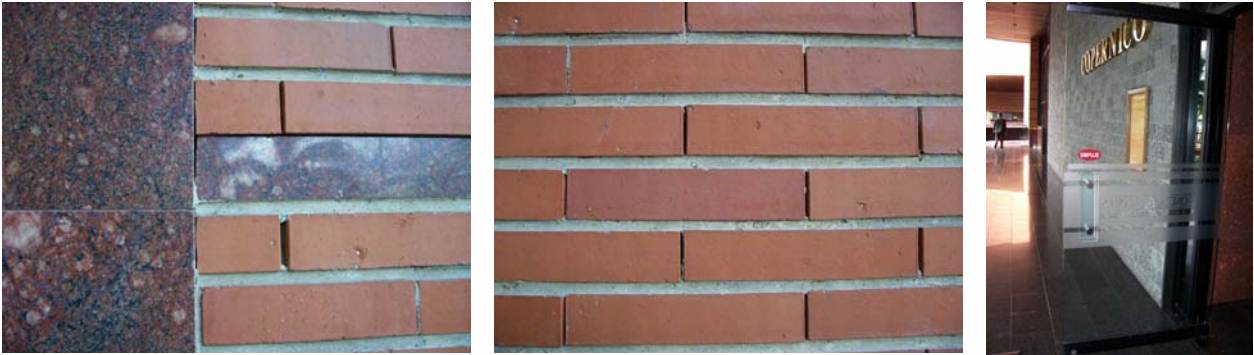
Fotos detalles revestimiento de panela de arcilla y mármol en fachadas, y vista de pavimento granito natural y piedra en pavimentos y paramentos.
